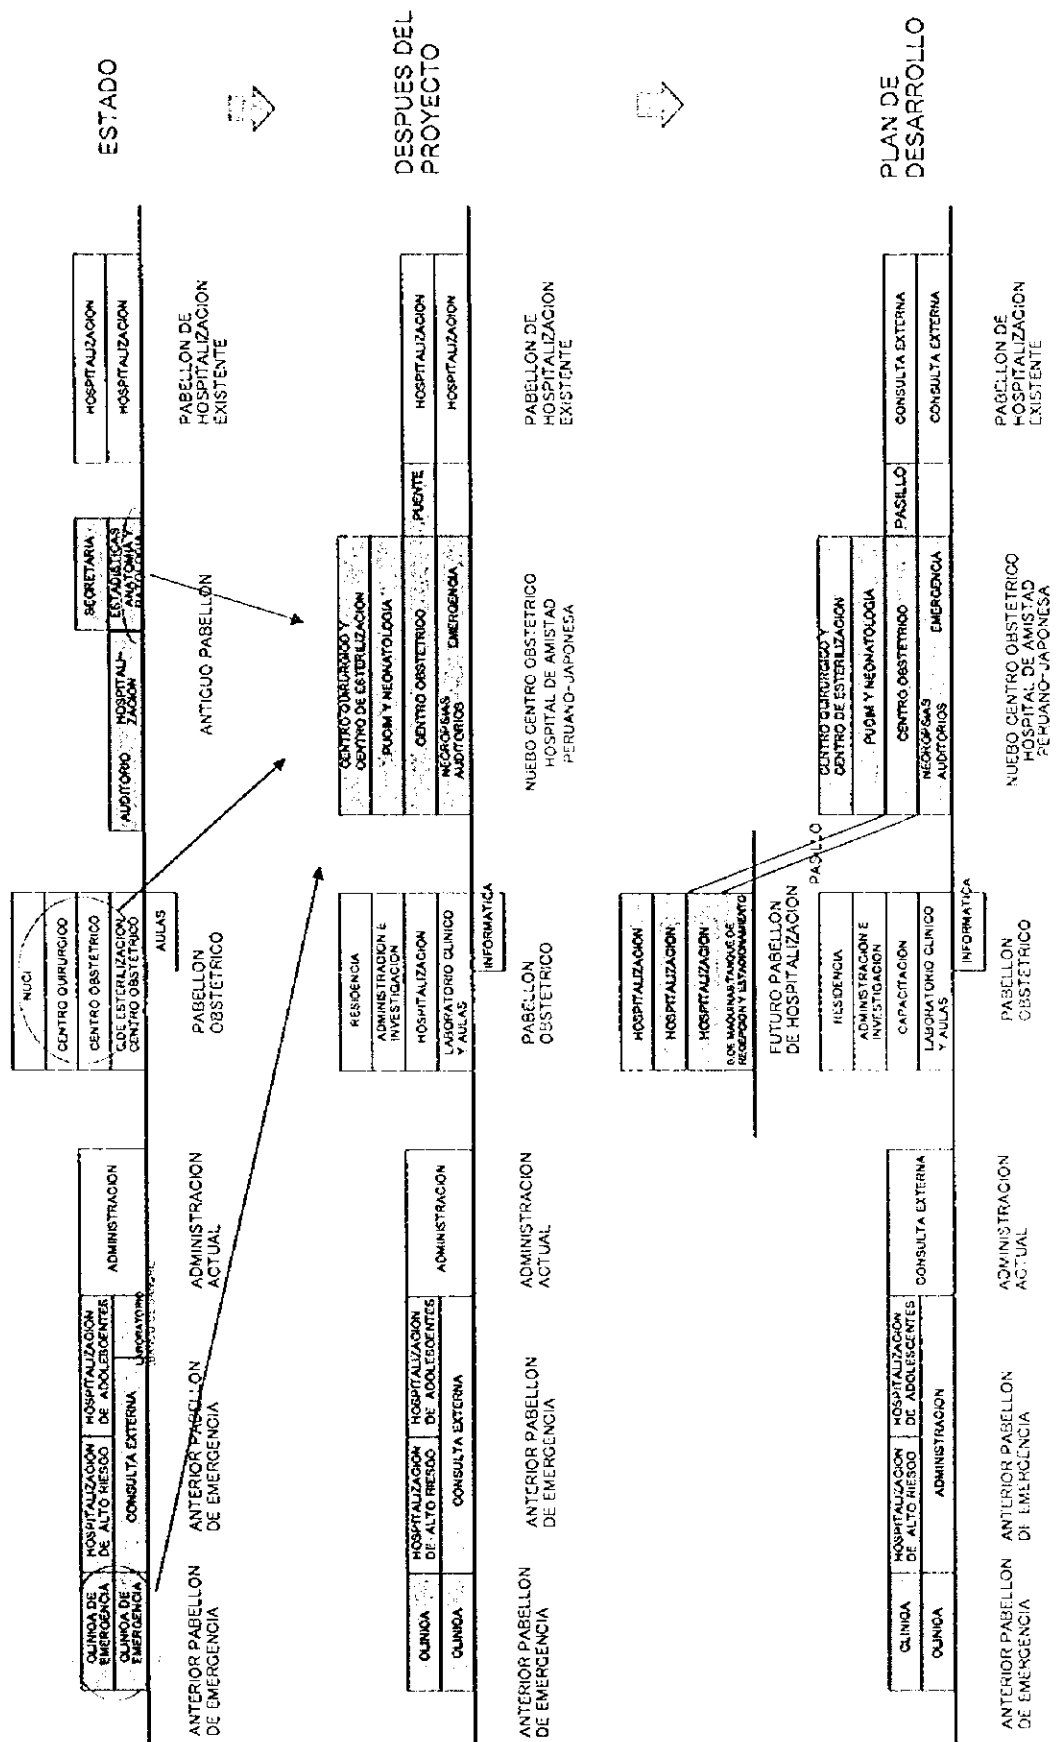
Sección de las infraestructuras antes y después del Proyecto y en el futuro
